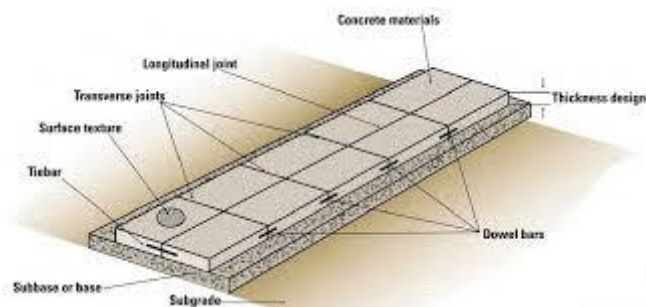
Característica de un pavimento de concreto con juntas (Menéndez, 2013)
